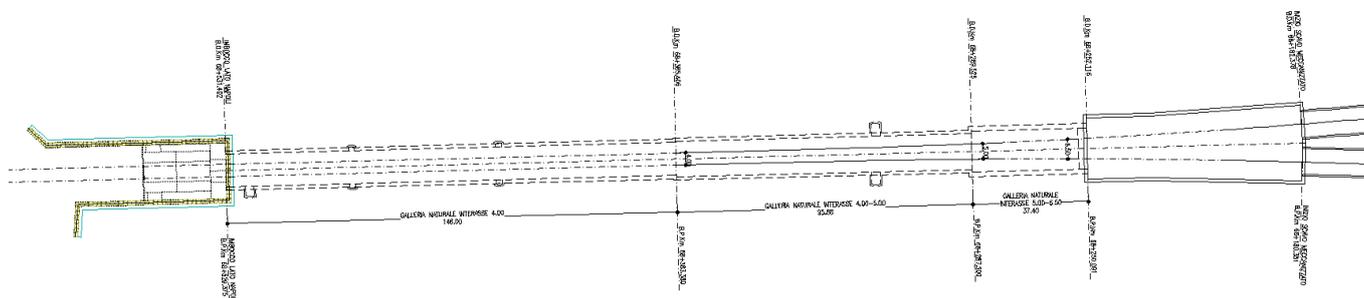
Planimetria imbocco GN Tradizionale imbocco lato Napoli
